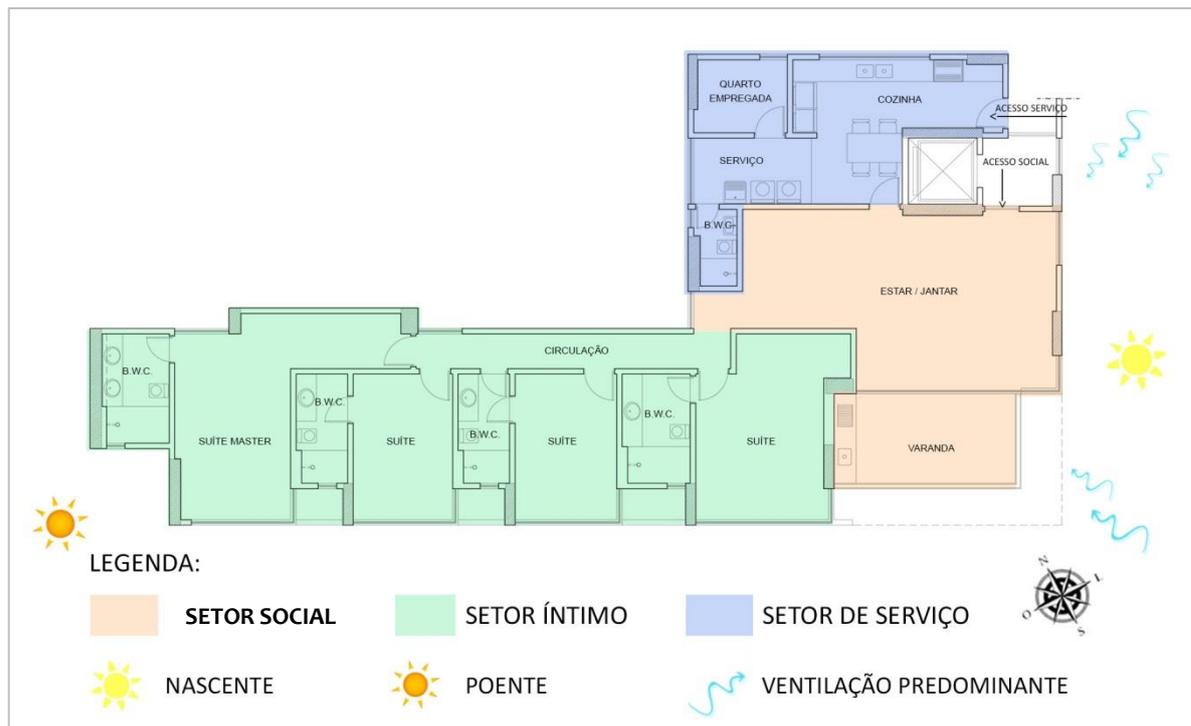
Planta baixa apartamento tipo terminações 03 e 04, condomínio Green Village. Fonte: Mendonça Engenharia (adaptada)
